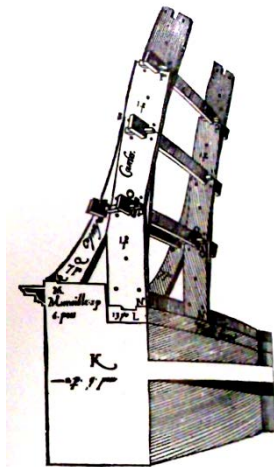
Detalhe do elemento estrutural de l'Orme [1]
